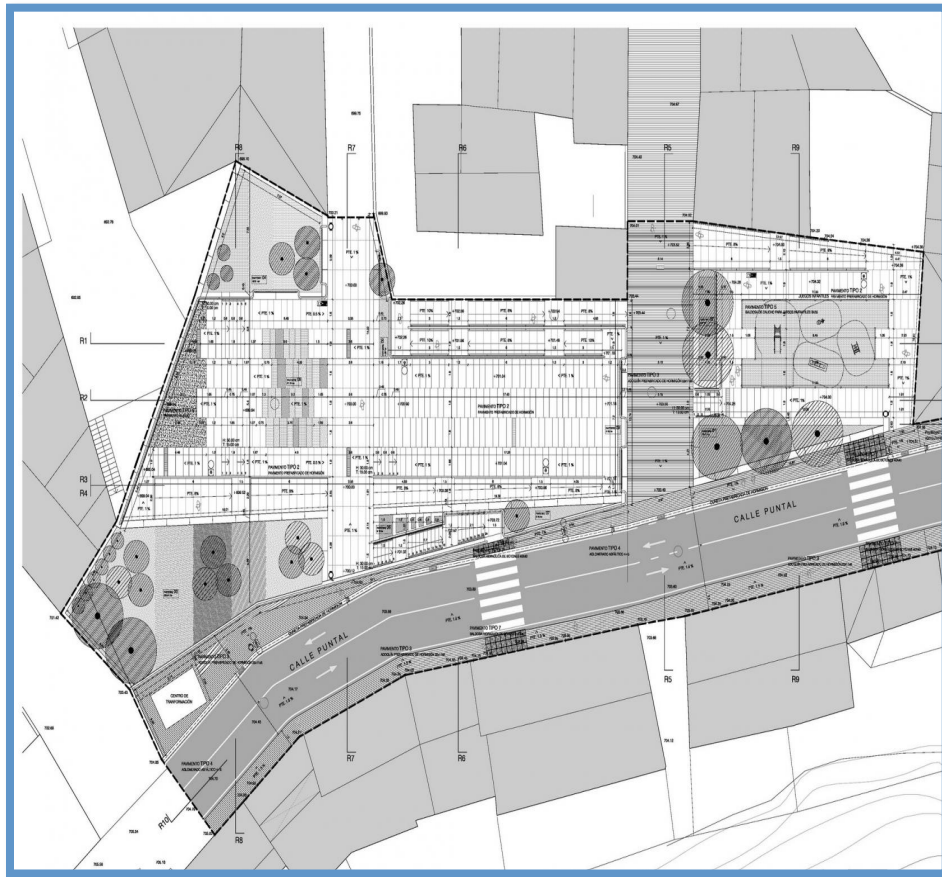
Planta de Plaza y Zona de Juegos Infantiles. Adaptado de Archello. (11 Enero 2016).
